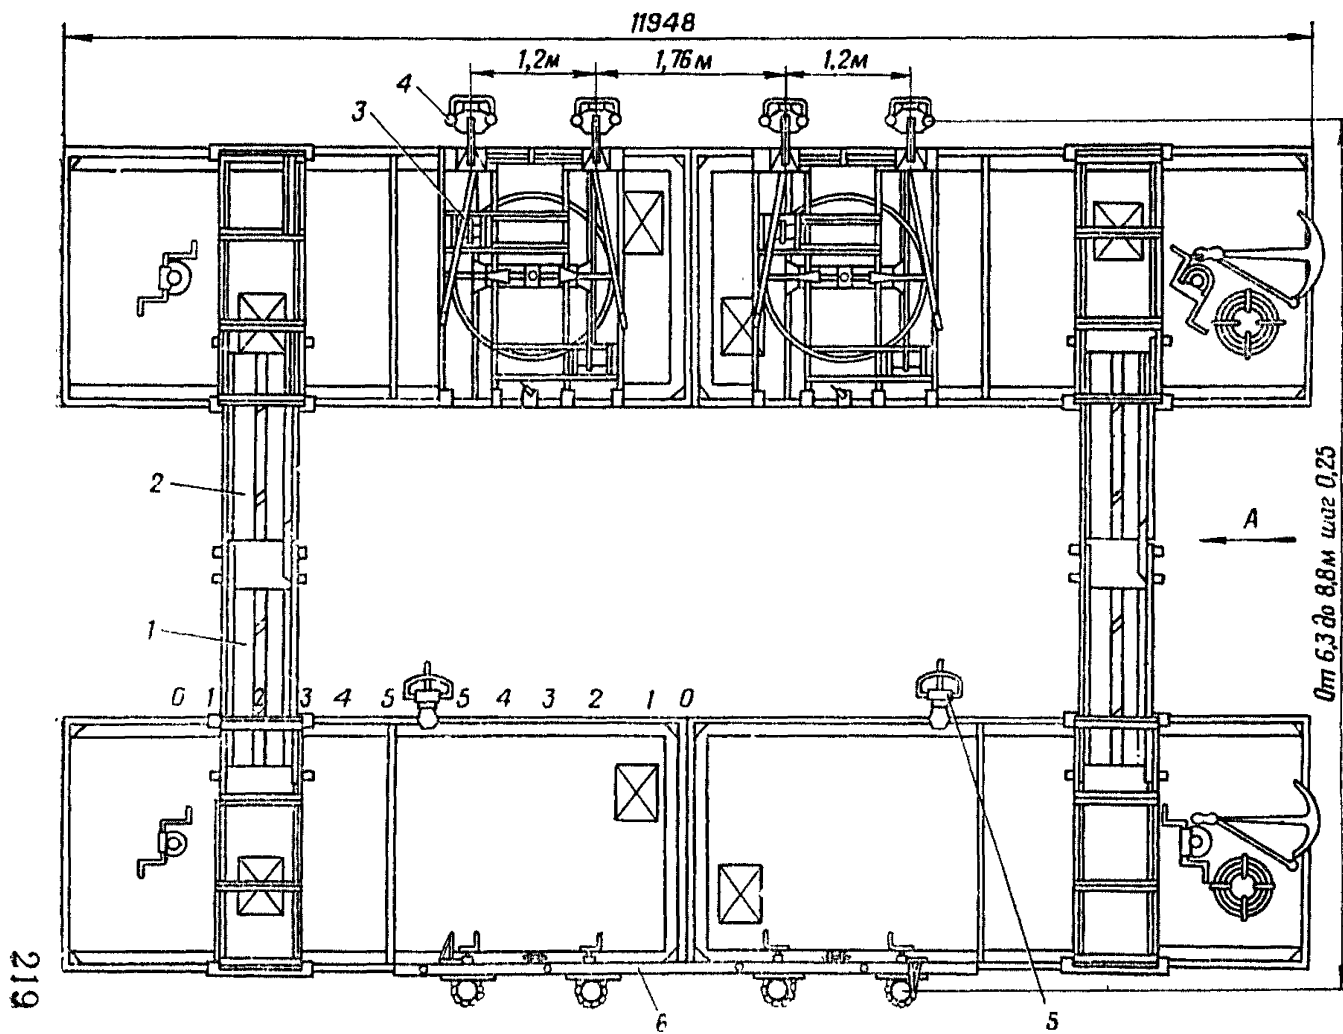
Сварьно-обстрочный паром, собраный по О-образной схеме:
